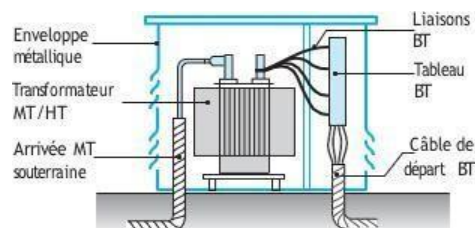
configuration d'un poste Compact préfabriqué [3]
